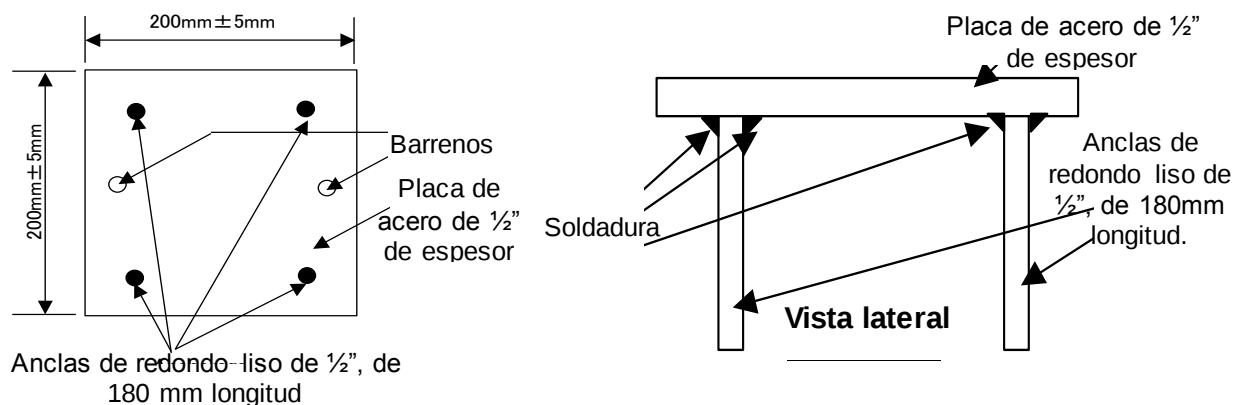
Detalle de las placas embebidas para el soporte de la placa de la trabe.
